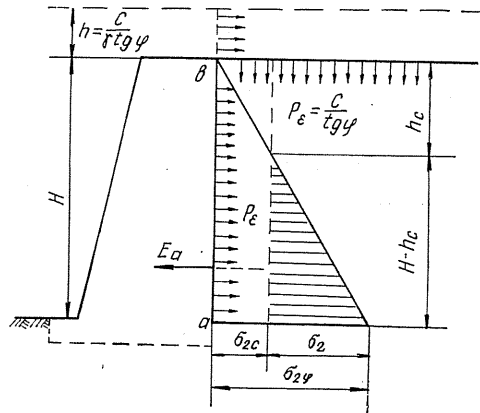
Схема к определению давления связных грунтов на подпорную стенку
